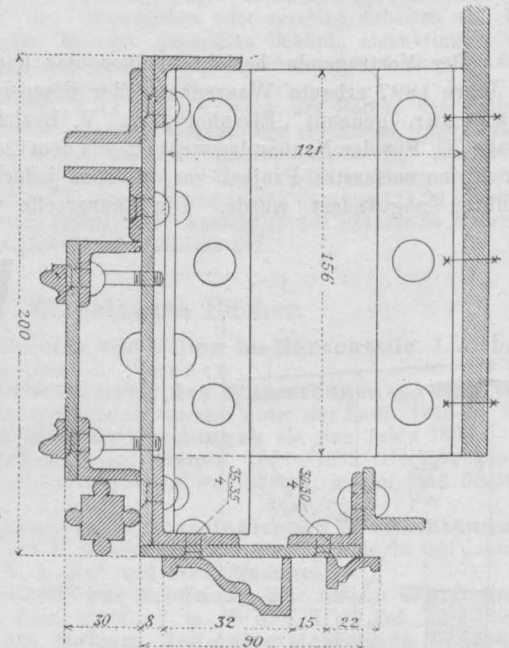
Schnitt durch ein Façadendetail, 1:3.
